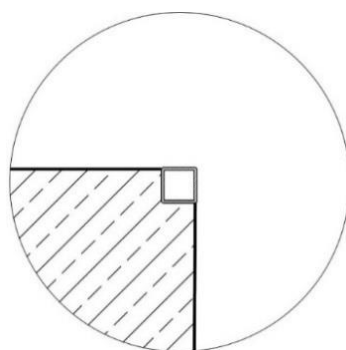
Profil równo „wtopiony” w krawędź elementu. Do profilu przyspawane marki z drutu stalowego w celu pewnego zakotwienia w betonie
